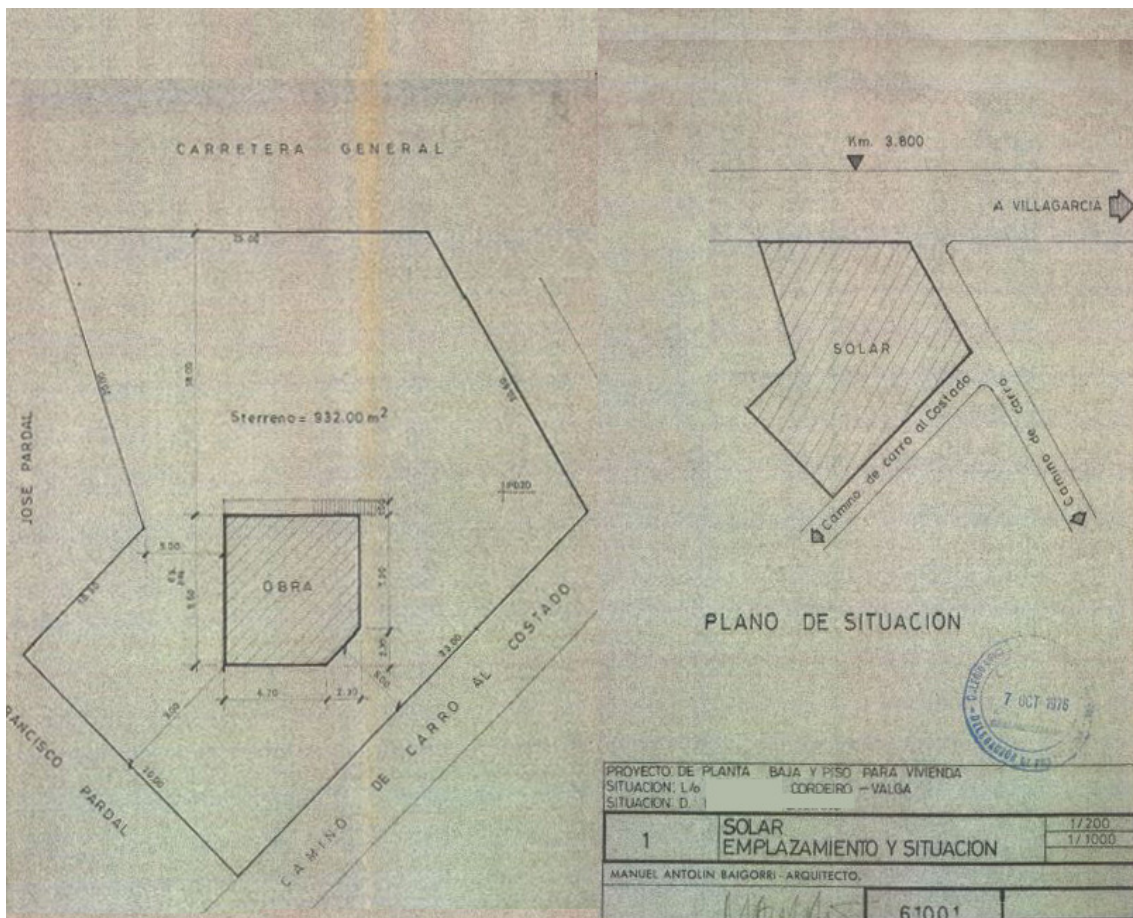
Ejemplo plano de situación y emplazamiento de una vivienda del año 1976. Fuente archivo municipal.
